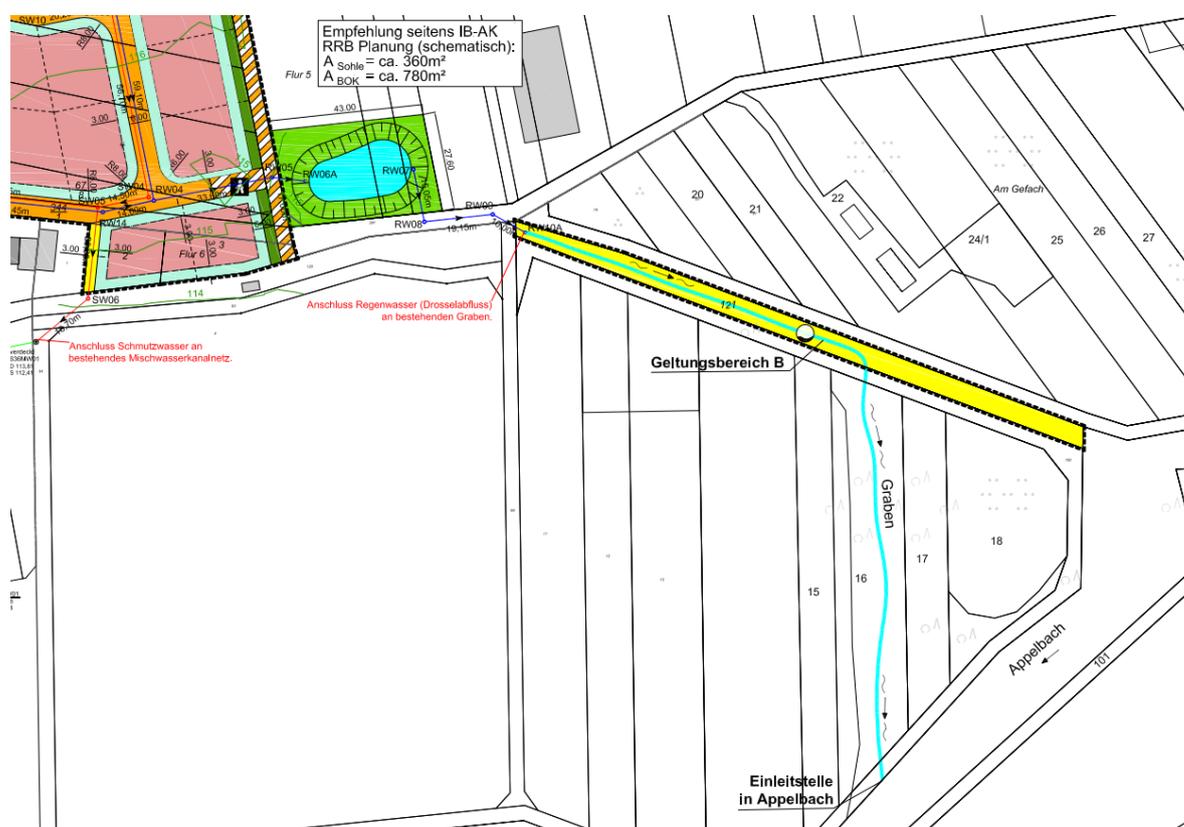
Auszug aus dem Lageplan zur Entwässerungskonzeption mit Darstellung des Mühlgrabens
